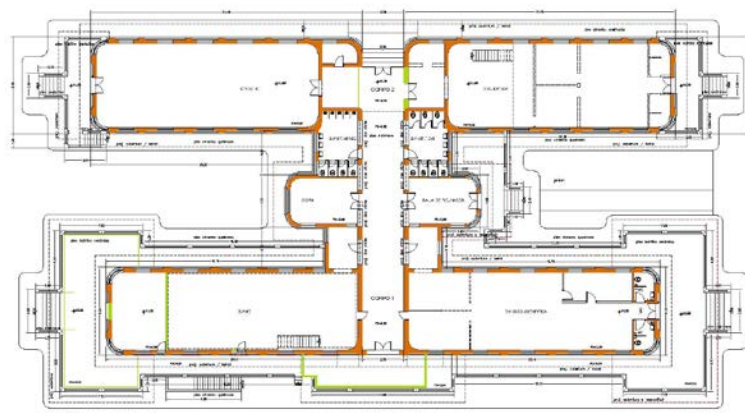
Planta do Pavilhão 2 do antigo Hospital de Isolamento de São Paulo, levantada por Paulo Fraga Silveira em 2002.
